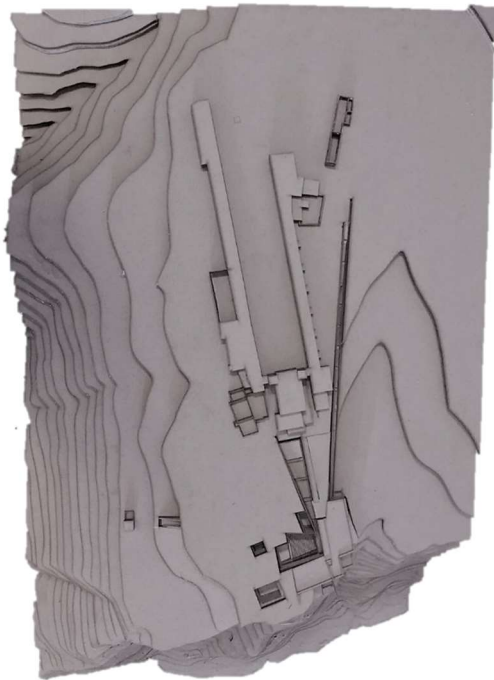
| Maquete da Proposta de Intervenção - Vista Superior
